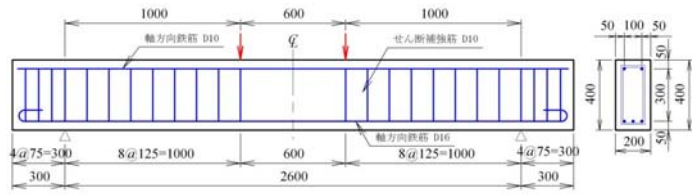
曲げ破壊型供試体の形状寸法および配筋状況
